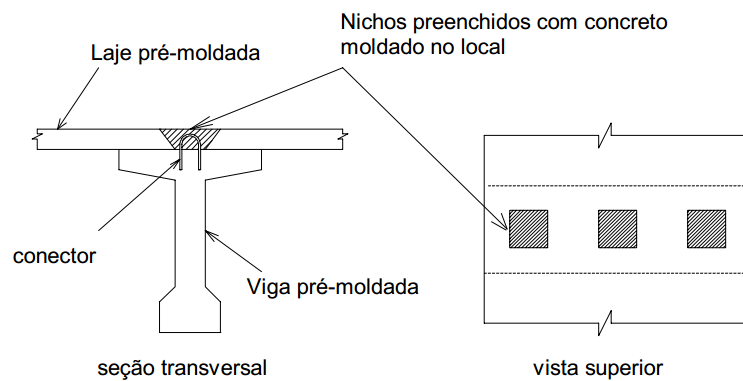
Ligação viga-laje por nichos preenchidos com concreto
